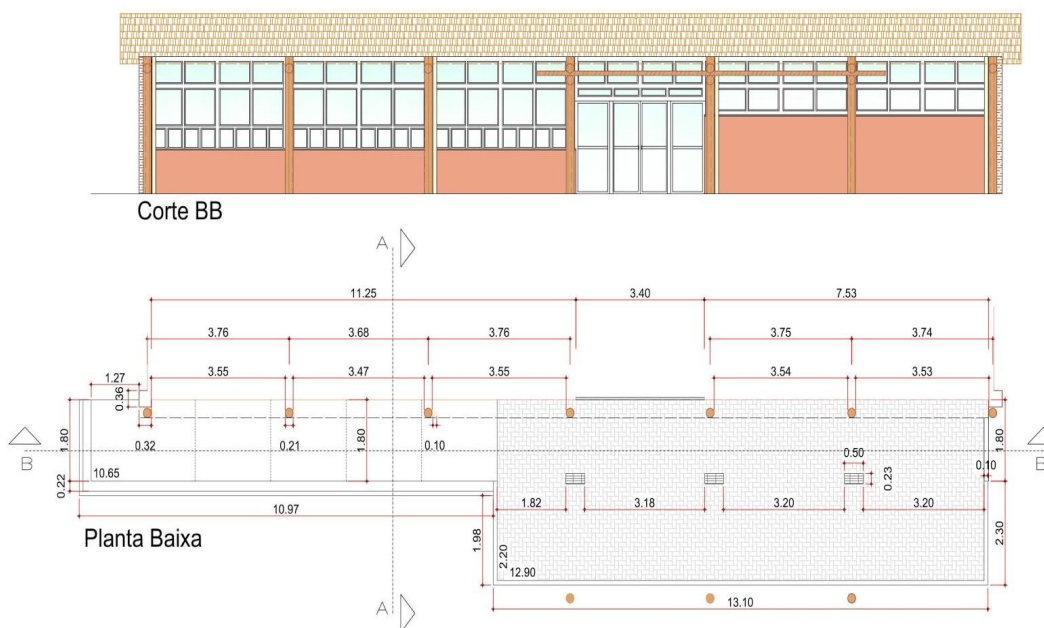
Planta baixa do local. Fonte: elaborado pelos autores.
